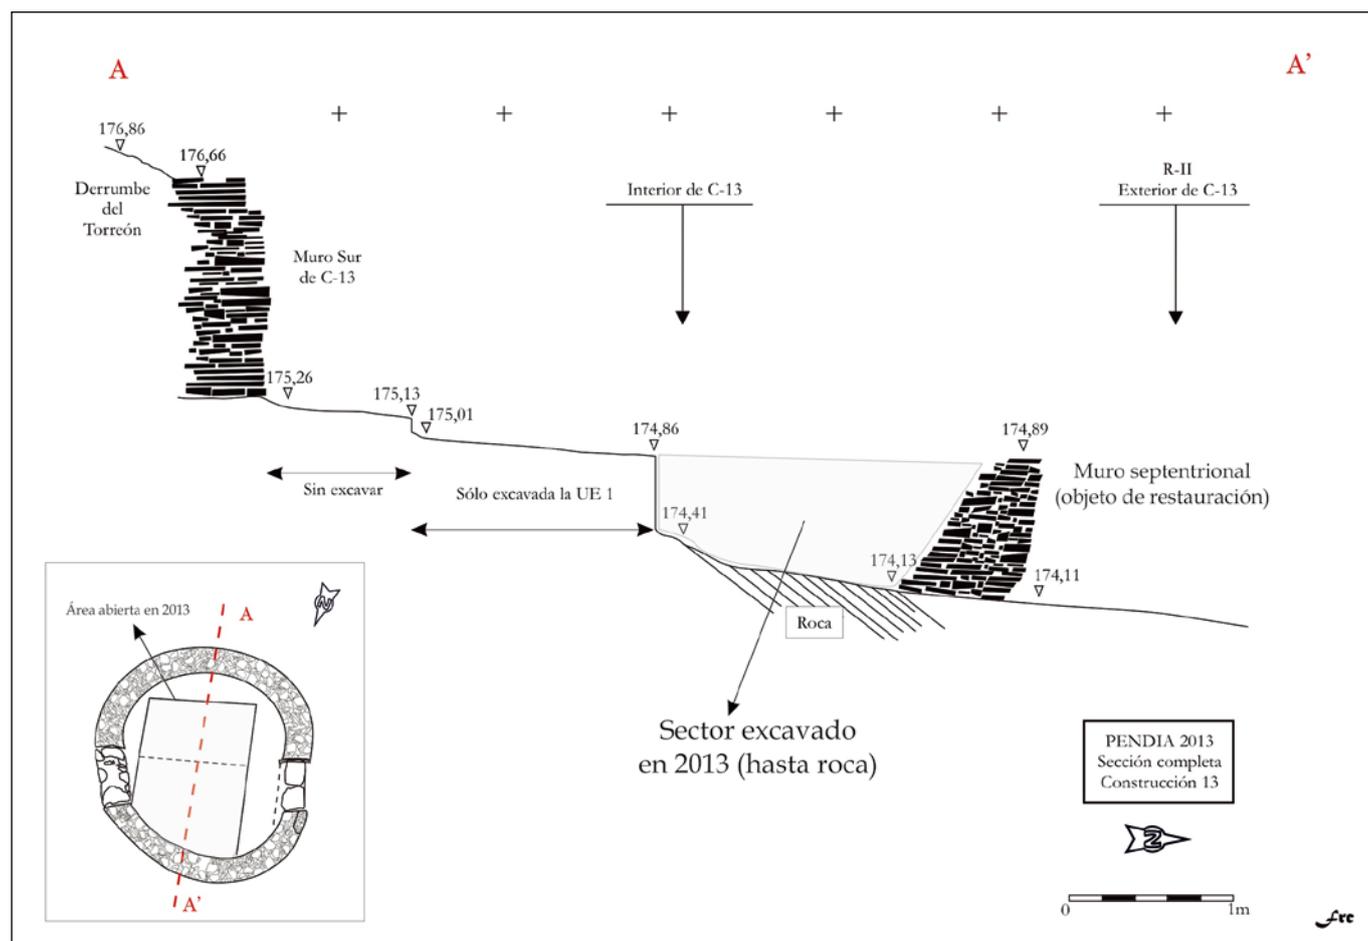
Perfil completo de la construcción 13 con las zonas excavadas y objeto de restauración.
